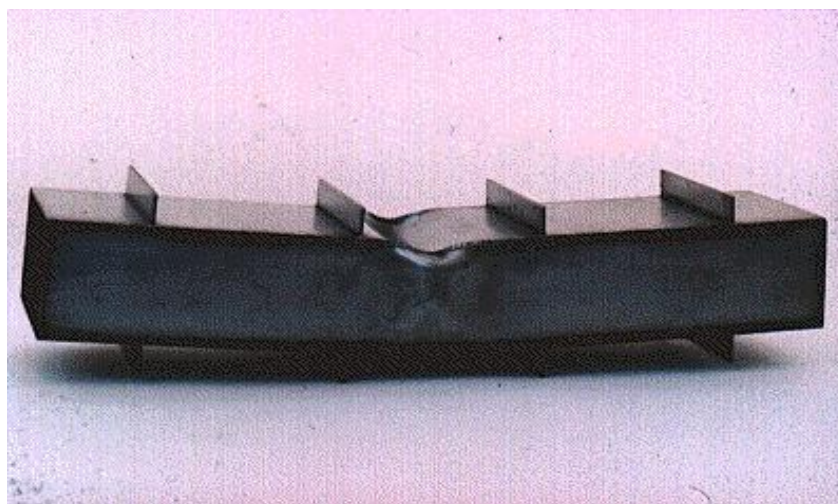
Ruine de la semelle comprimée d'une poutre en caisson.
